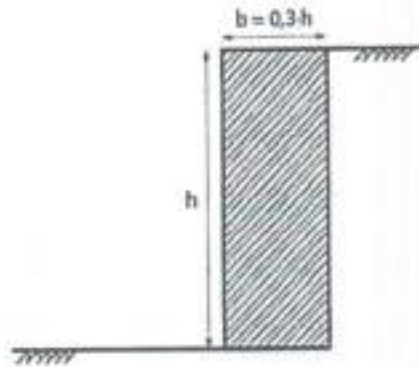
Dimensionamento de muro de gravidade do tipo retangular.
